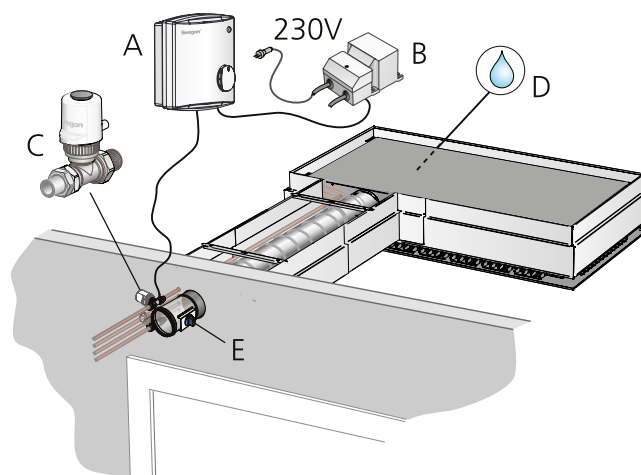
Installation mit Ventil, Stellantrieb und Klappe im Korridor
